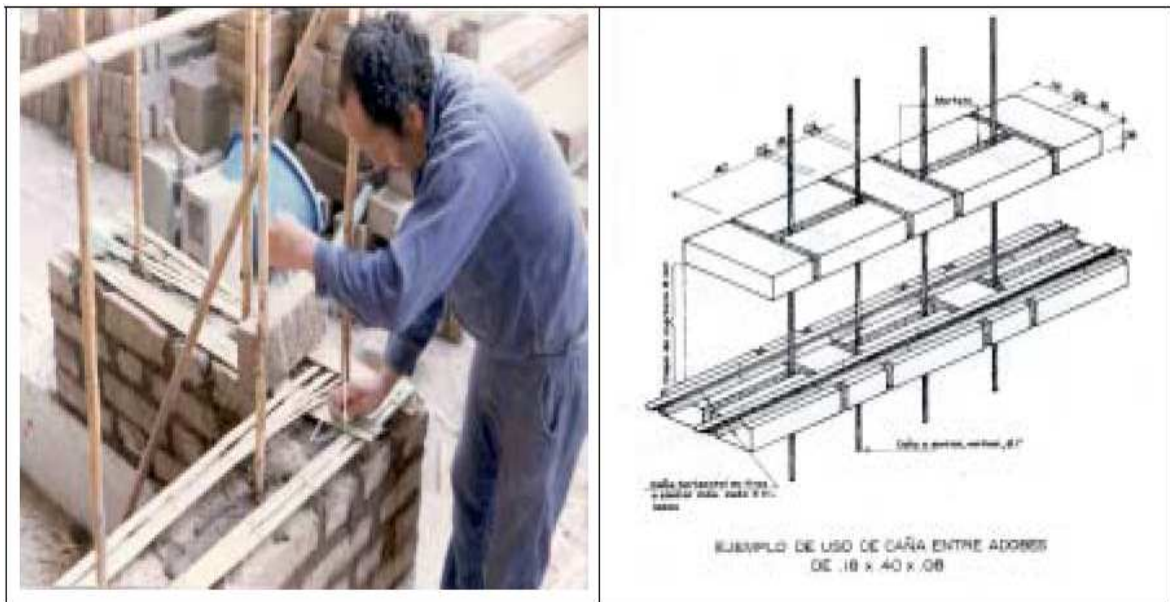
Colocación del Refuerzo de Caña en Perú
